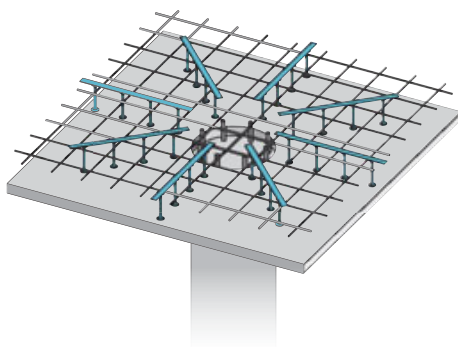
Flachdecke mit PSB Durchstanzbewehrung
